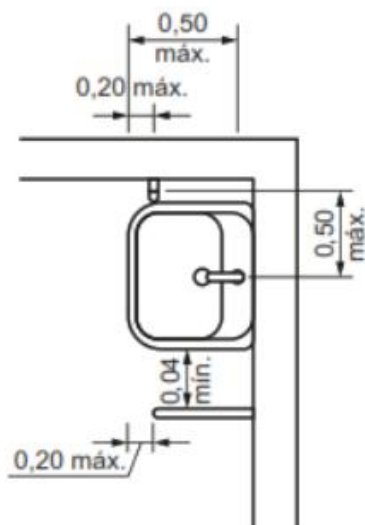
Vista superior de lavatório com barras horizontais e verticais
